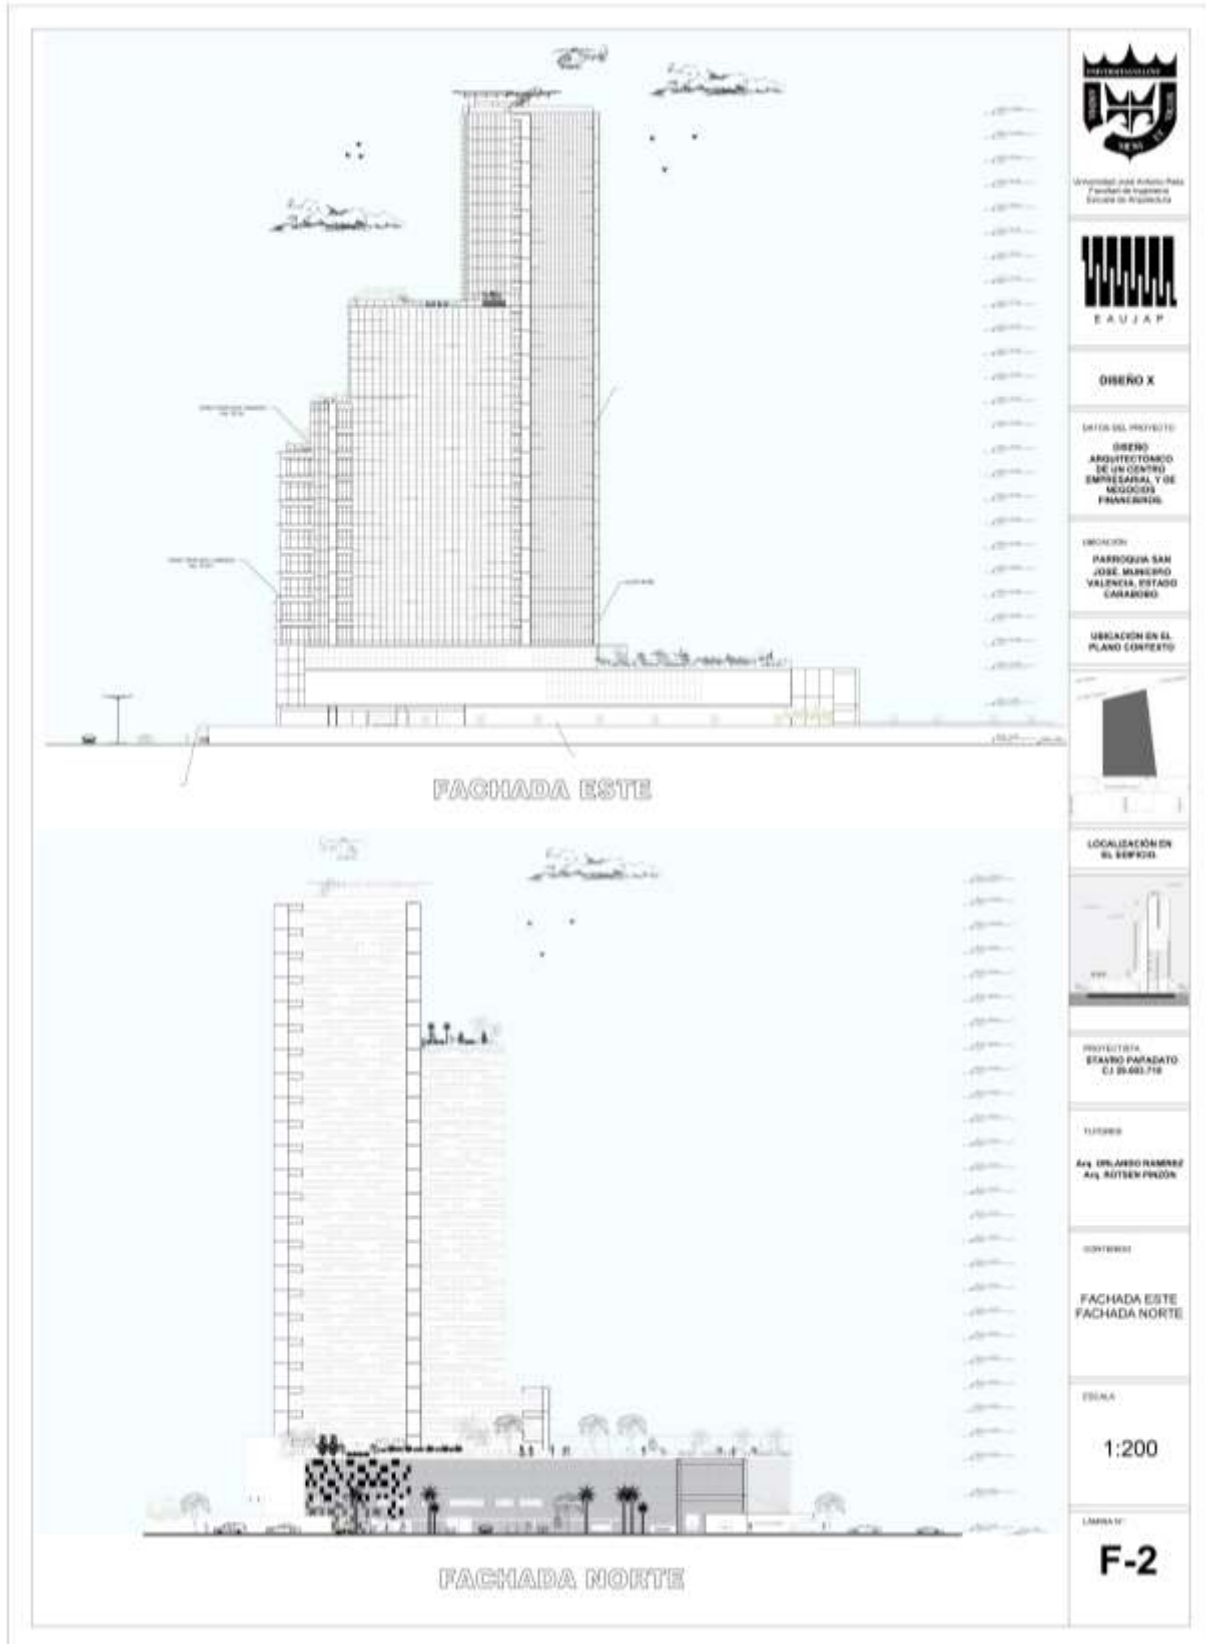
F-2 Fachada Este / Fachada Norte Fuente: El Autor (2023)
